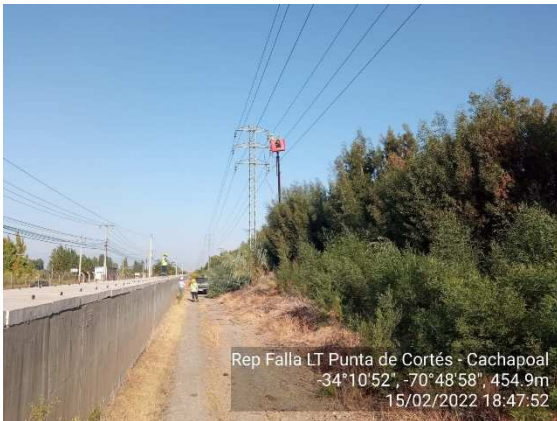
En la fotografía se muestra la faenas de reemplazo de cadena de aislación dañada por descarga en estructura N°21
